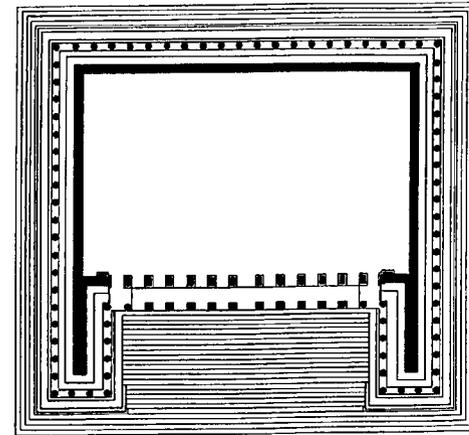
Pergamonaltar, Grundriss (nach Kähler)
